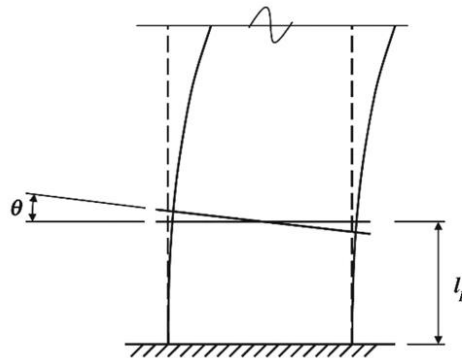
Rotación en la articulación plástica en un muro de concreto (ACI 369, 2022)
